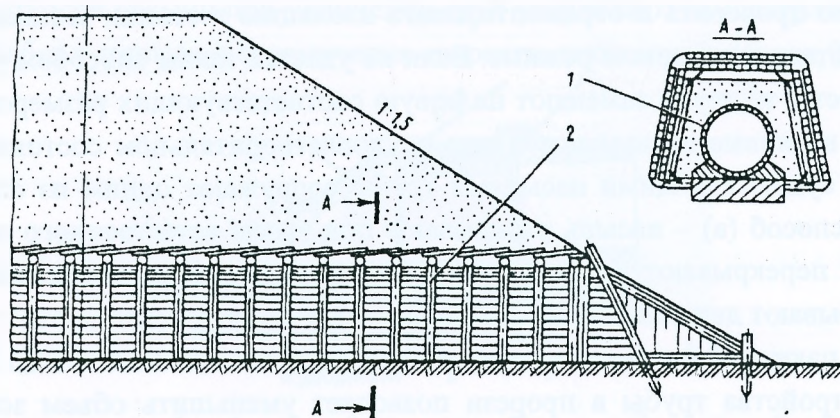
Устройство трубы в насыпи штольневым способом: 1 – сооружаемая труба; 2 – крепление штольни.
